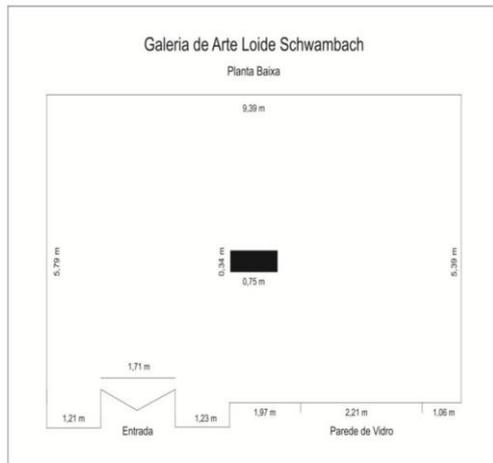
Figura III: Imagem da planta baixa da galeria Loide Schwambach.
